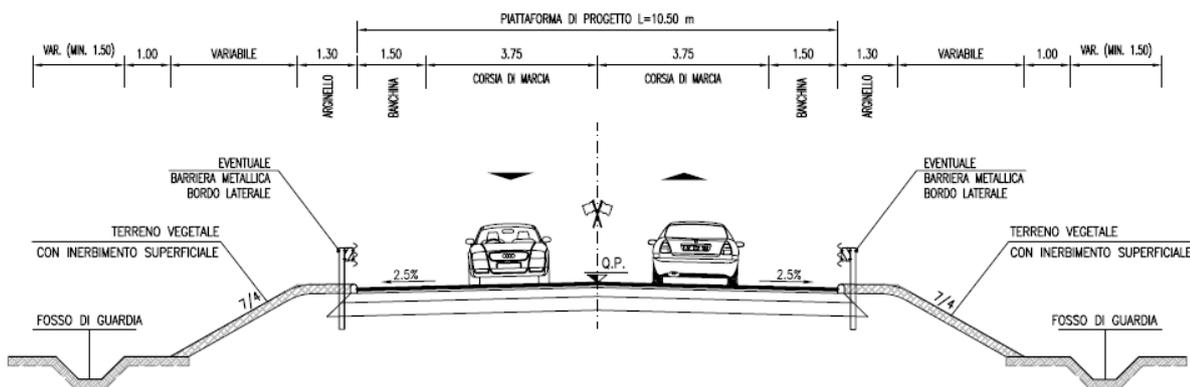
Sezione tipo in rilevato – Cat. C1 extraurbana secondaria
